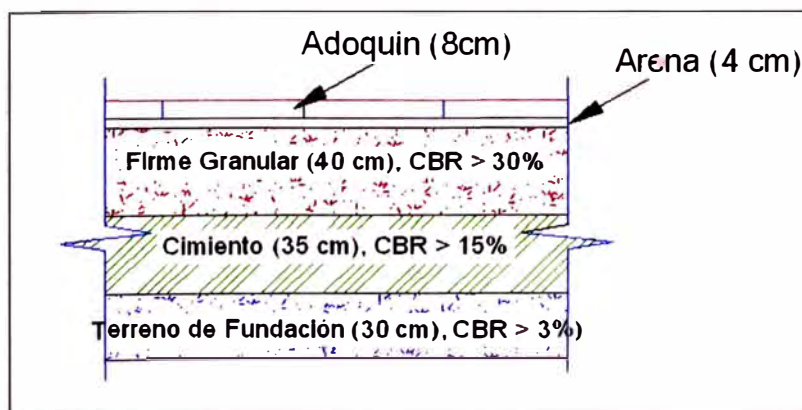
Detalle del pavimento adoquinado en el patio de almacenamiento.
